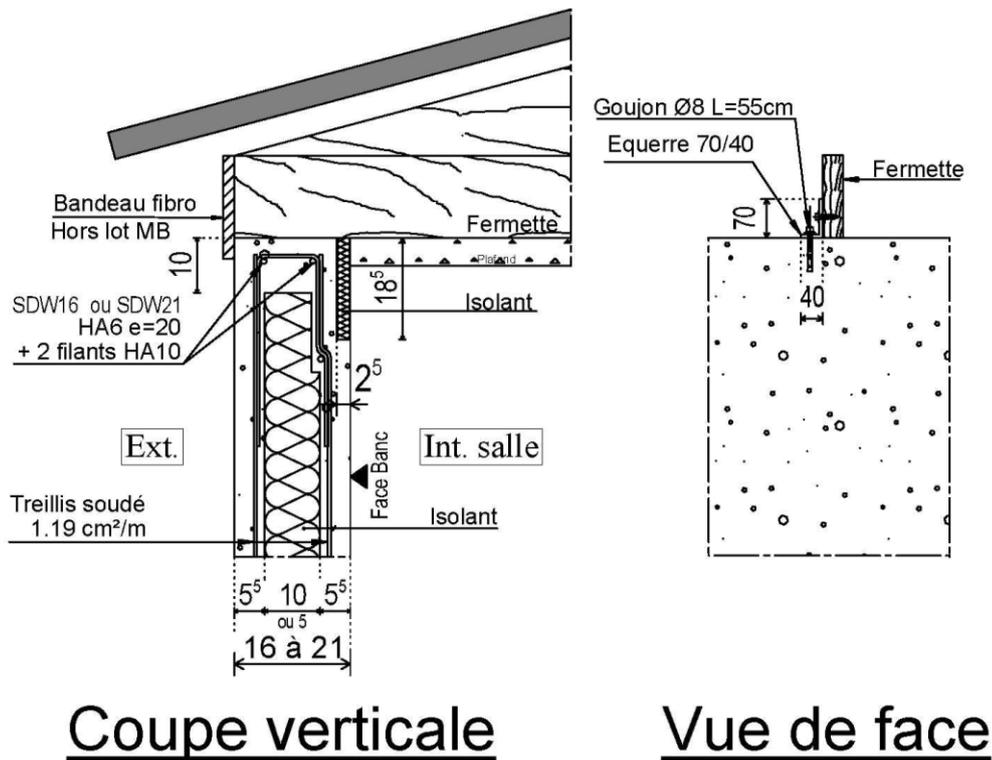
Panneaux sandwichs de façade posés sur soubassement - détail des fixations mécaniques en tête
